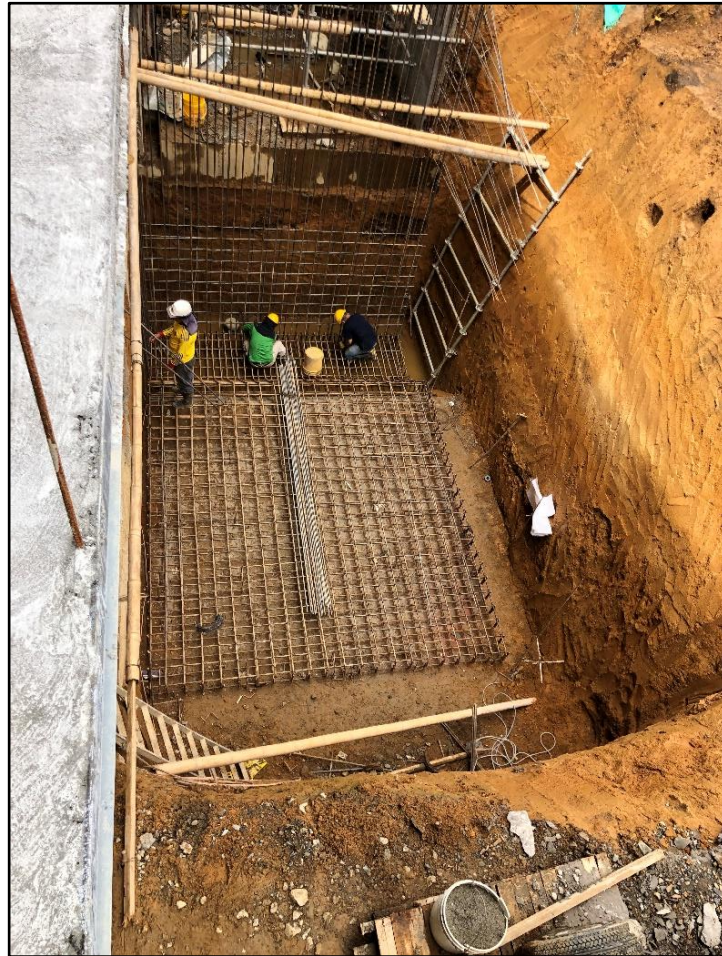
Armado de parrilla de refuerzo. Fuente: tomada por el pasante.
